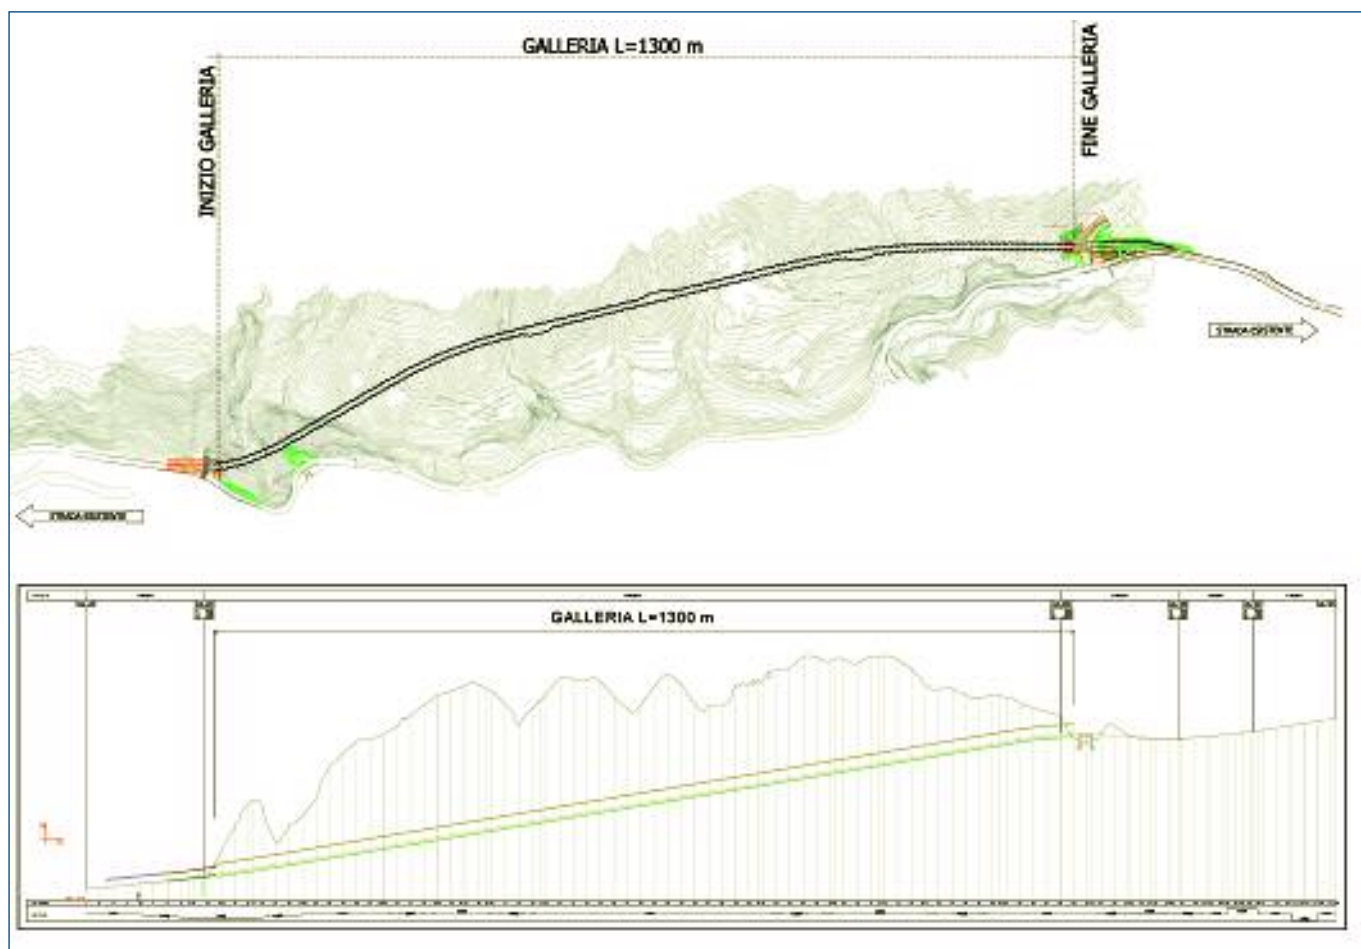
Planimetria generale e profilo longitudinale della galleria
